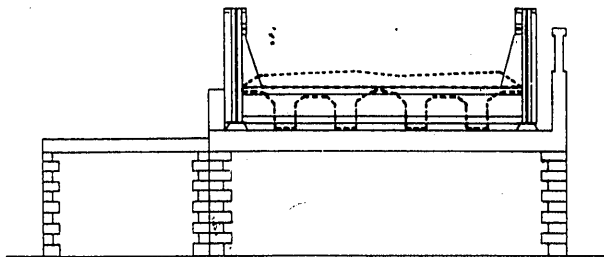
Sustrucción del puente metálico del Argaunza, por tableros de hormigón armado.
